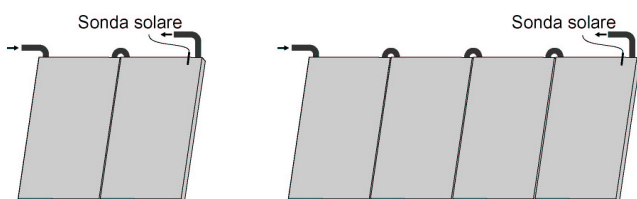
Collegamento in serie di collettori verticali (max 5 Helio Plan 2.2 in serie).
